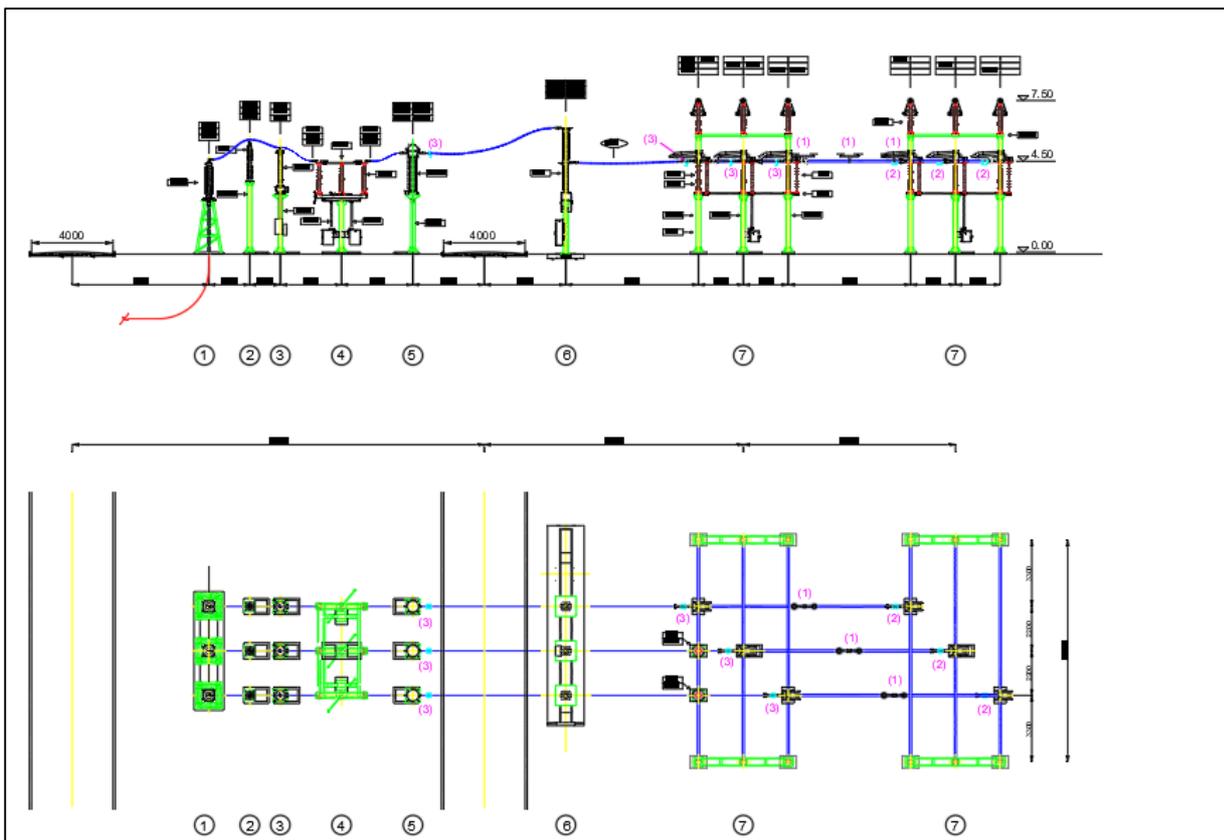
vista laterale e vista in pianta Stallo Arrivo Produttore 150 kV
